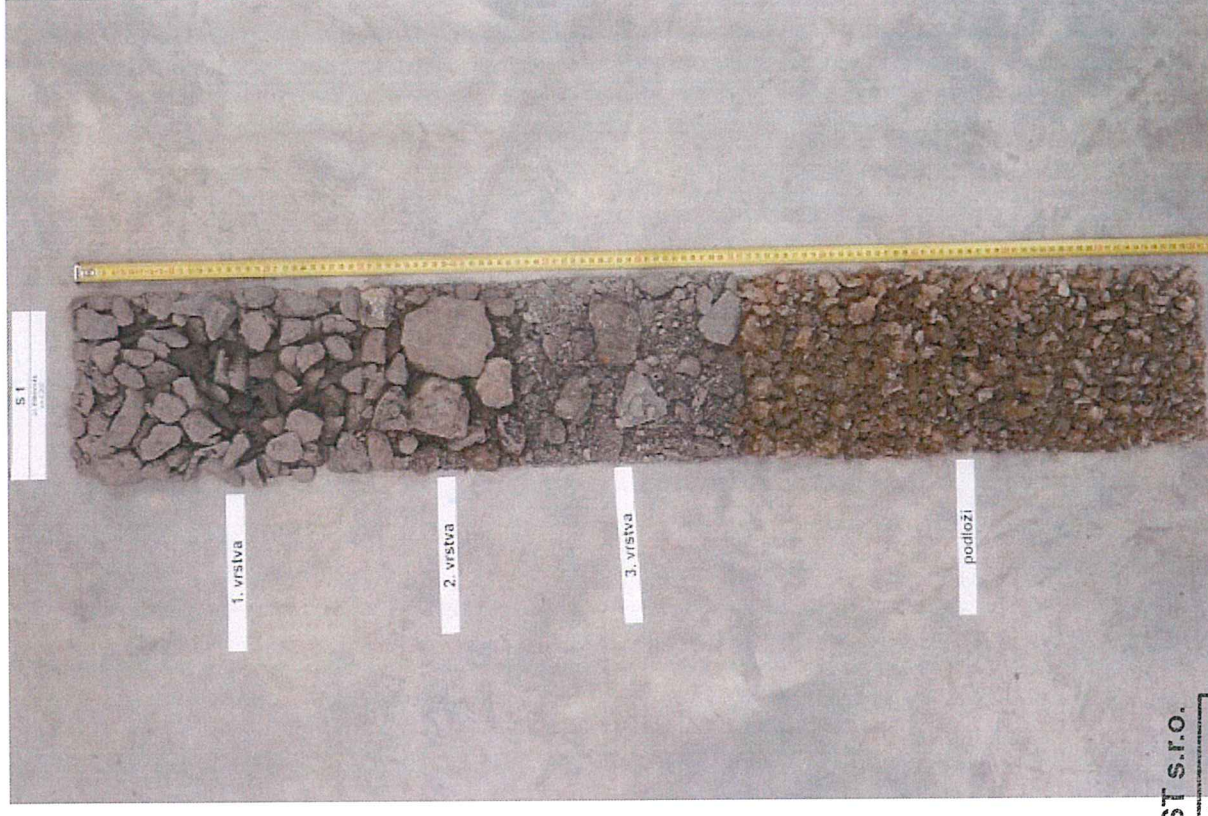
Detail jednotlivých vrstev sondy S1
